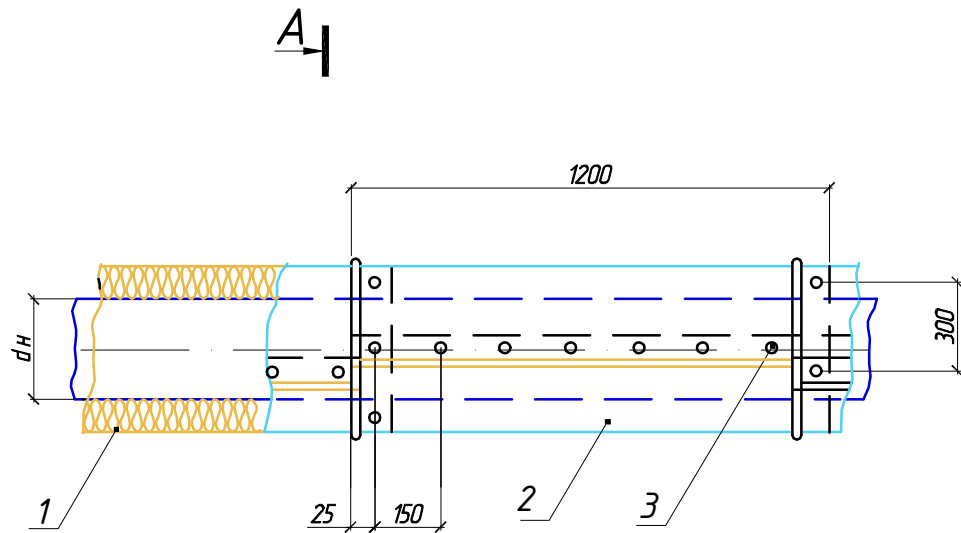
Крепление покрытия изоляции трубопроводов бандажами
